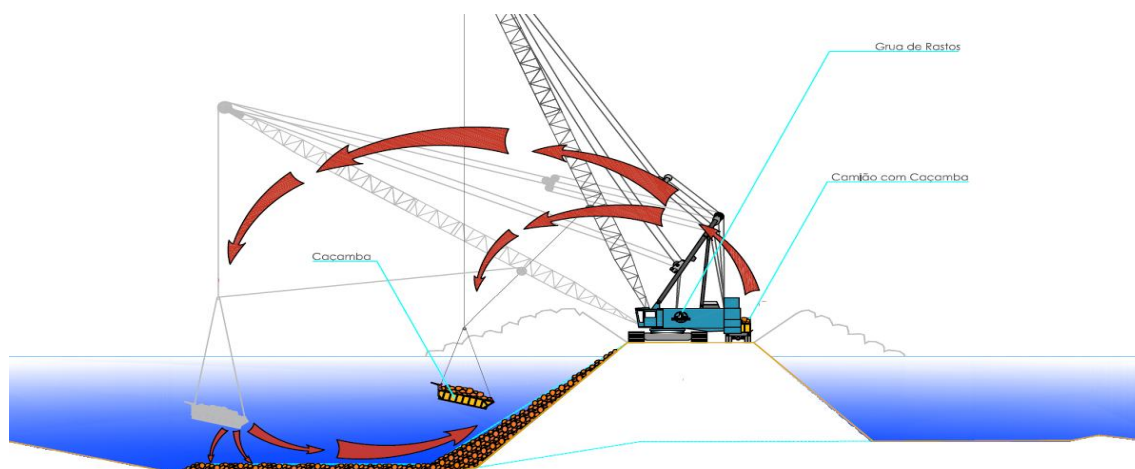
Construção da segunda subcamada, colocação de TOT e enrocamentos por meios terrestres, esquema em corte longitudinal 1. (ETERMAR – Engenharia e construção S.A.)
